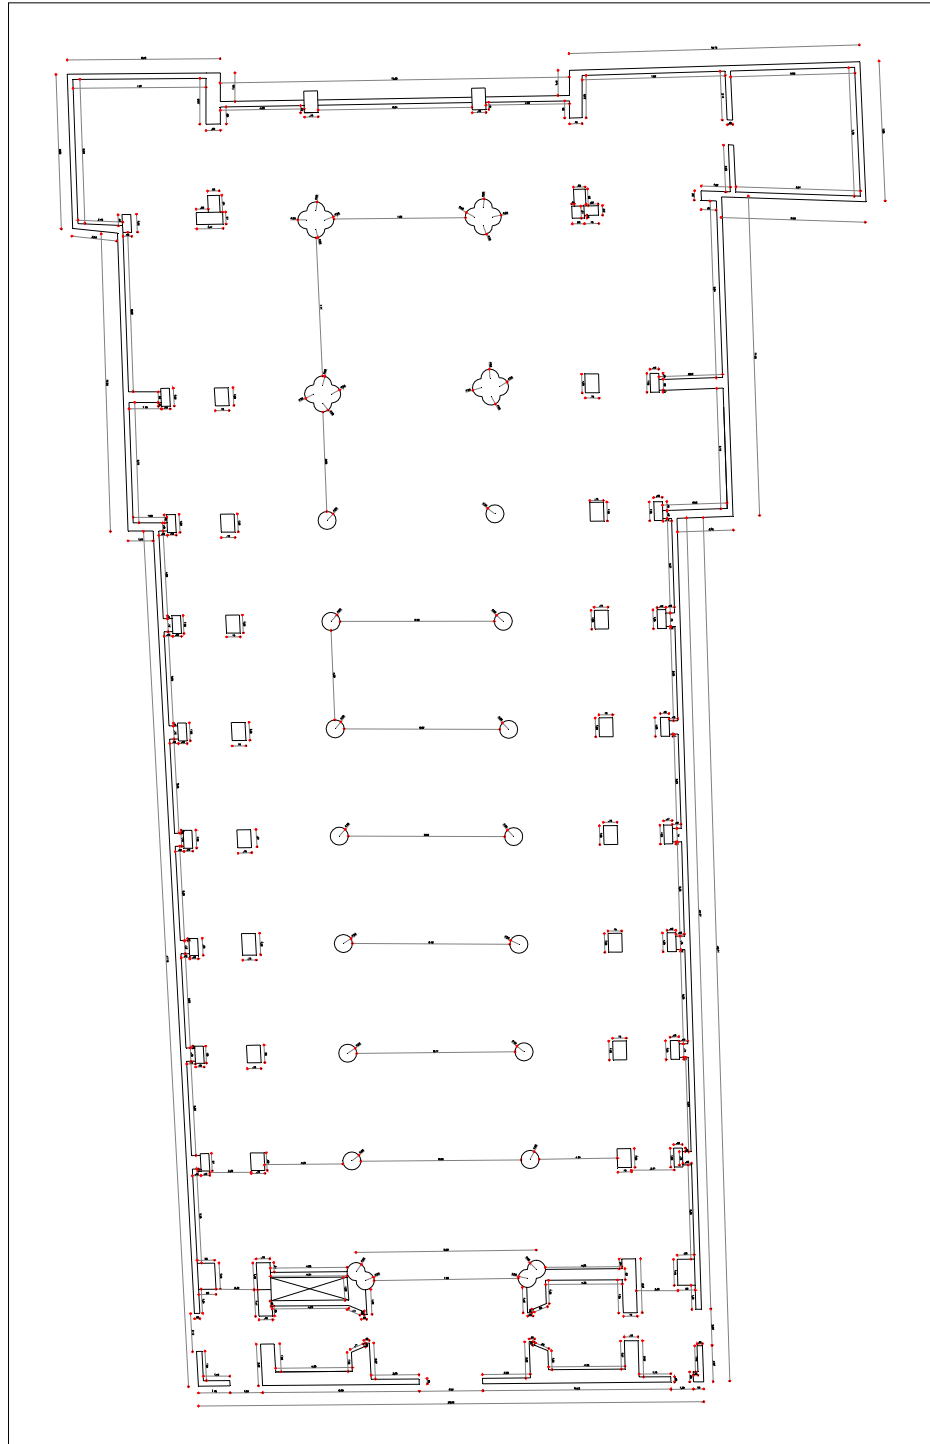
Vista en Planta Catedral de la Sagrada Familia
